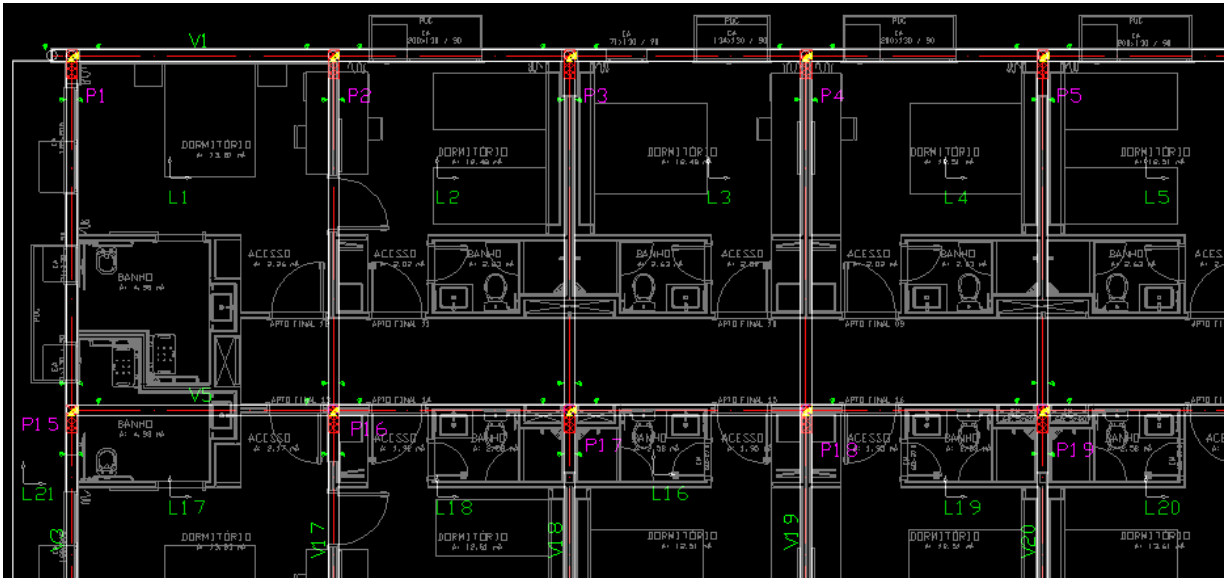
Inserção das vigas e lajes no modelador estrutural do TQS. (Fonte: Autor, 2023)
